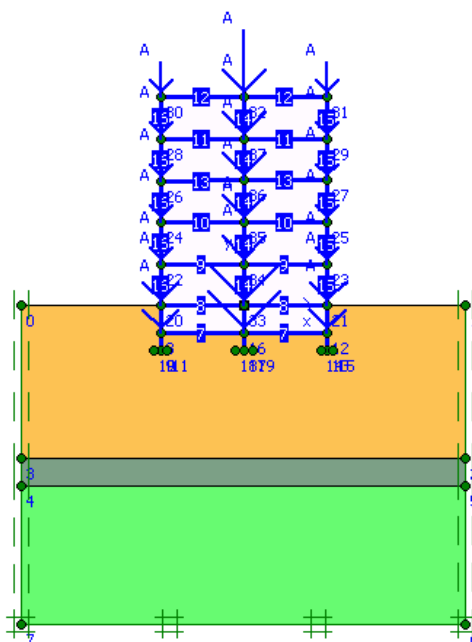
Схема № 4. Задана надземная часть здания с перекрытиями. Нагрузка передается как сосредоточенная в узле опирания перекрытия на стену
